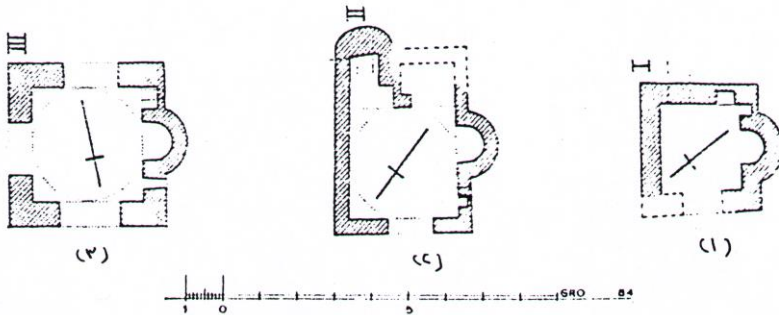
مسقط أفقي لكنيسة ٣ بتل محرض - وادي فيران نقلاً عن
